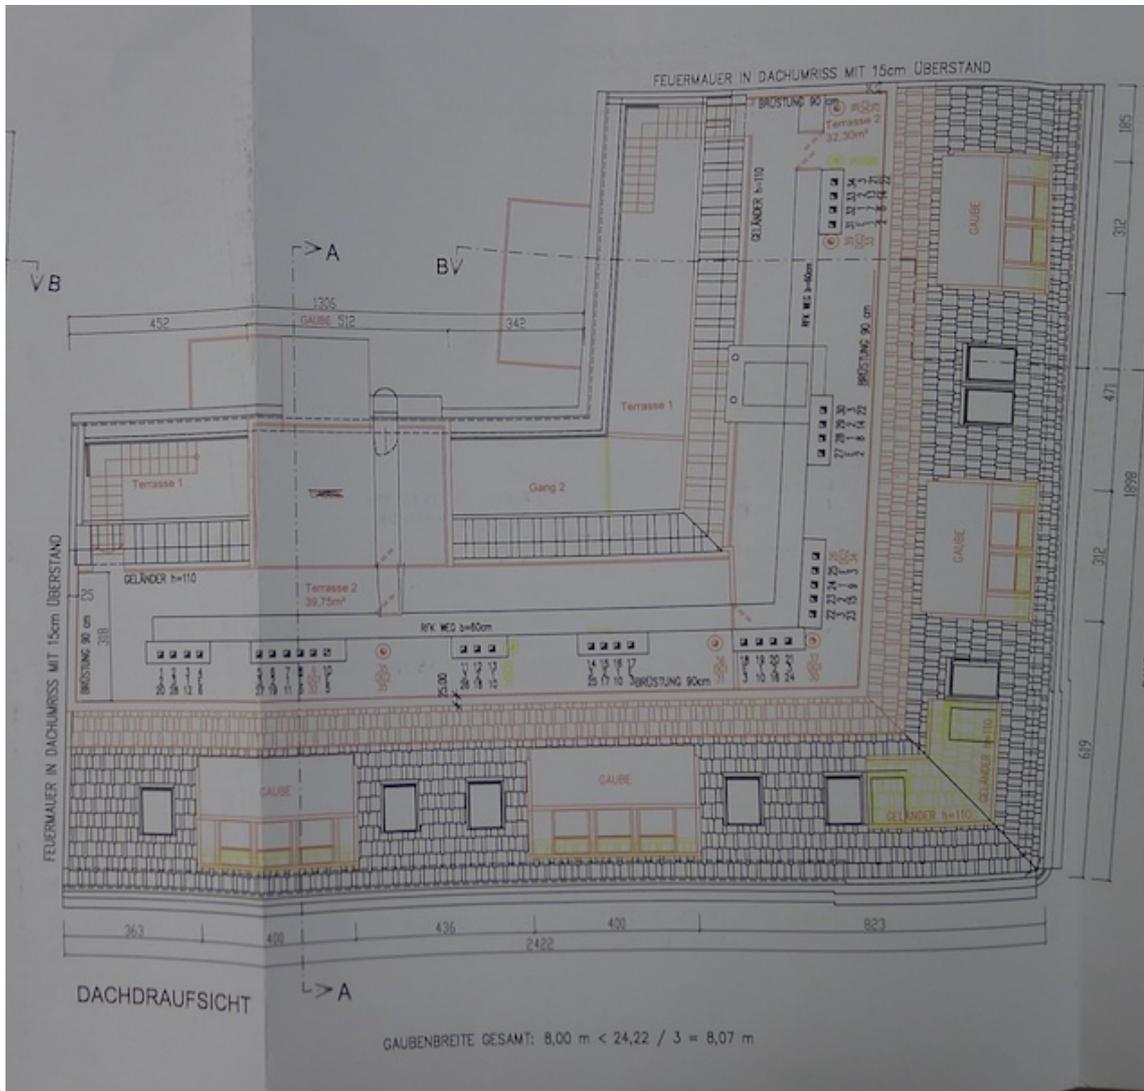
Grundriss 2. Dachgeschoss gem. Auswechslungsplan
